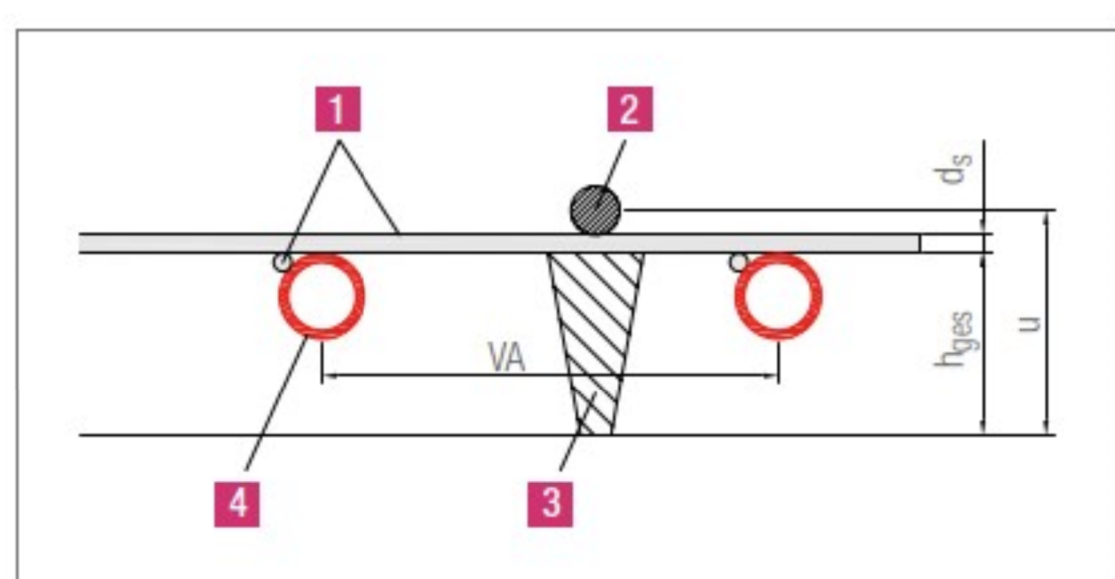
Aufbau untere Bewehrung, Schnitt (Detail)
